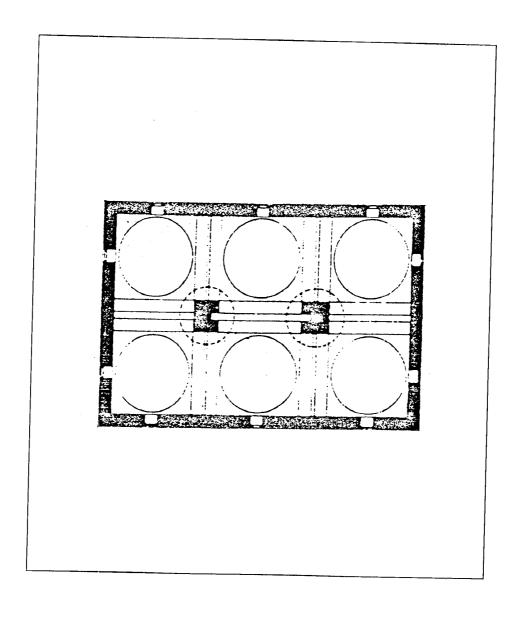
مسقط أفقي لجلطة بادستان بإستانبول (عن :Cezar) .
